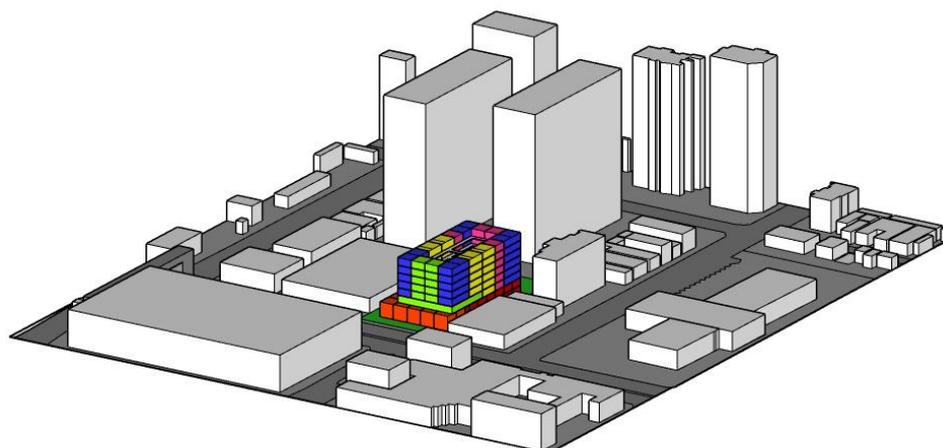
Zoneamento do pavimento tipo e volumetria da proposta final
